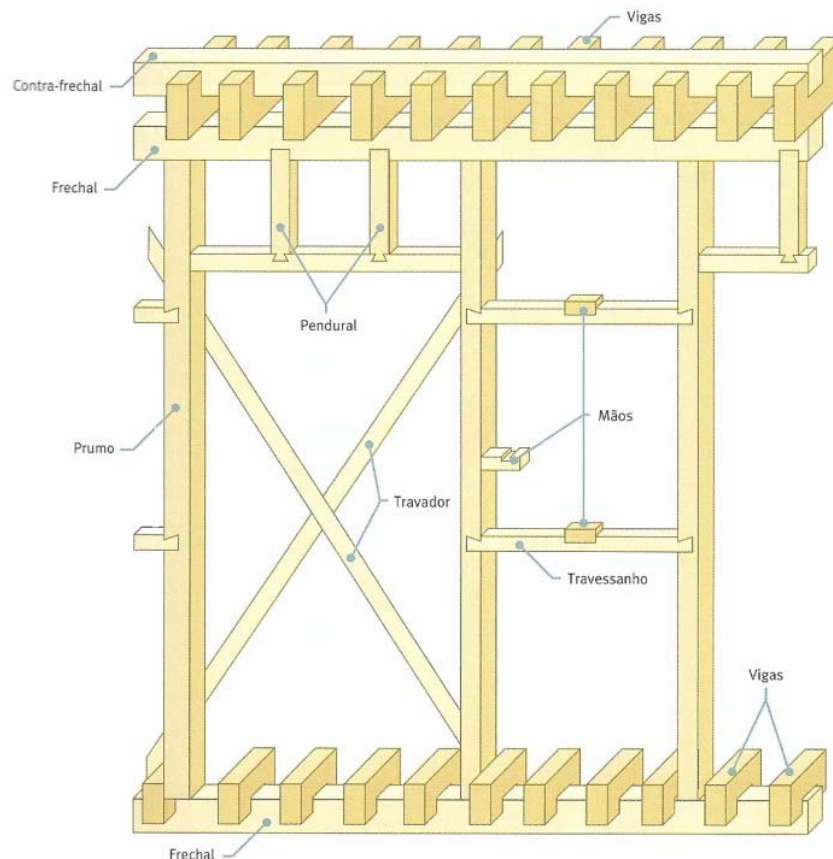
Estrutura de madeira das paredes exteriores [1]
